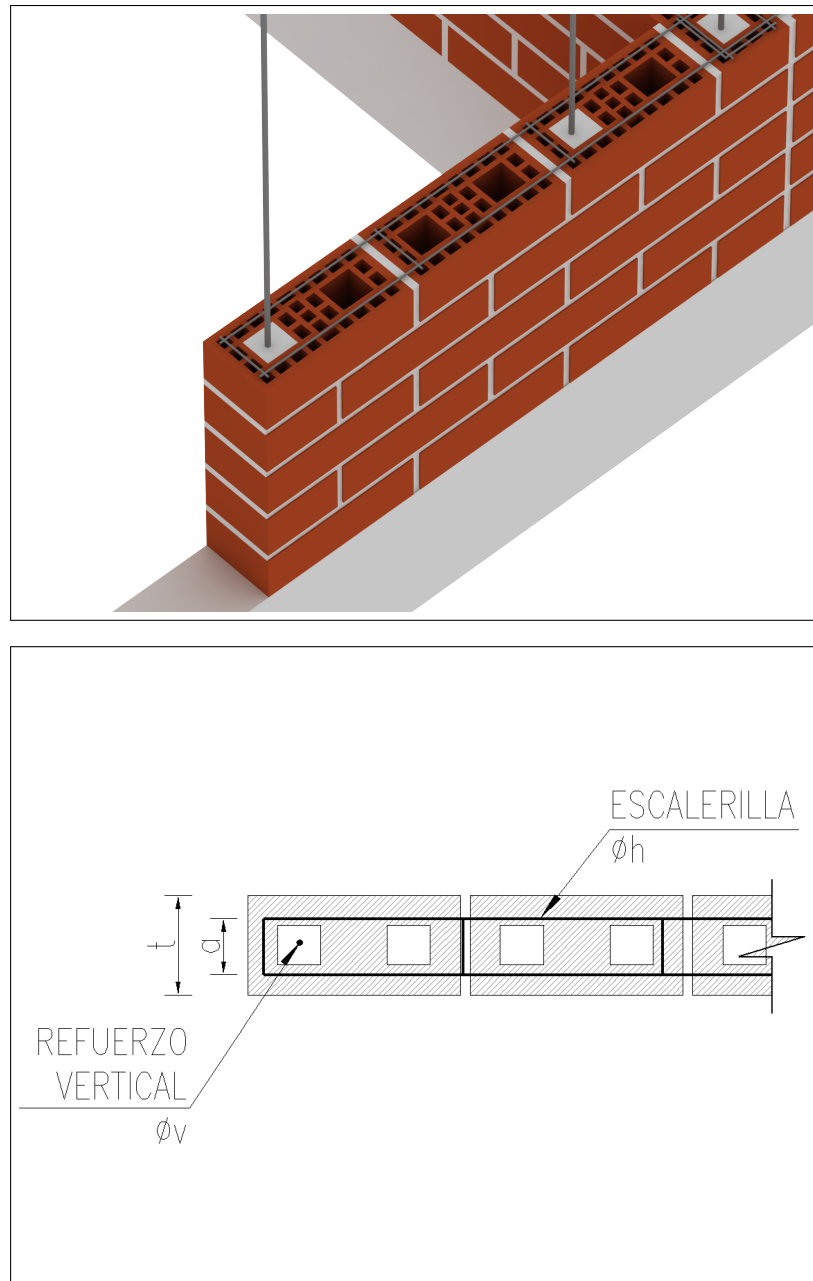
Anclaje del refuerzo horizontal (escalerilla) en el borde libre de un muro. Alternativa A.
